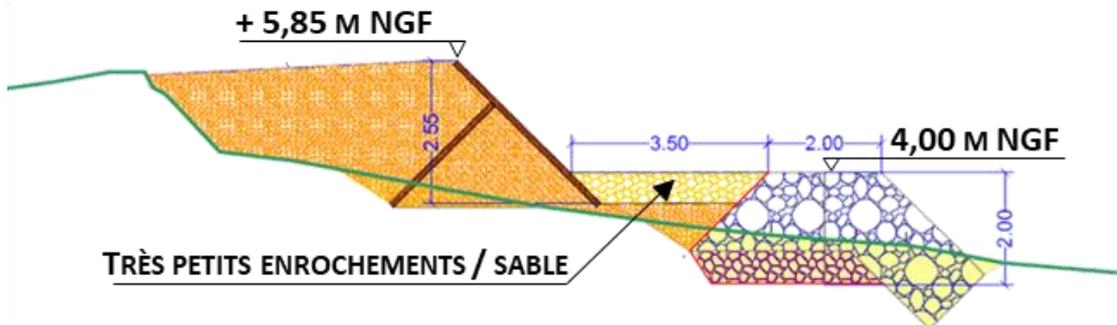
Coupe type de l'ouvrage actuel (Source : CD56).
